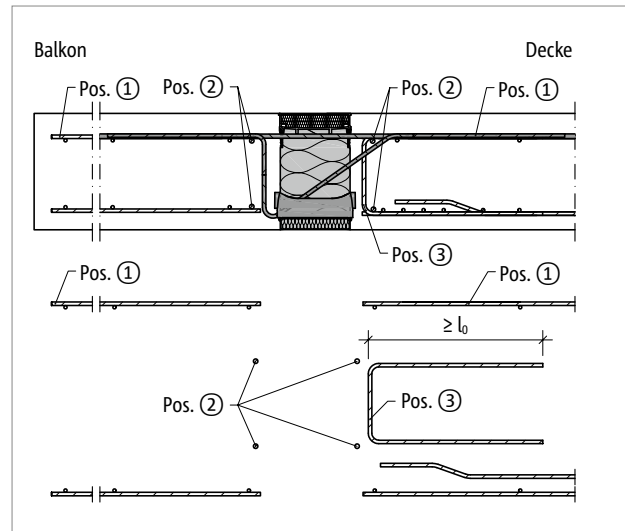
Schöck Isokorb® XT Typ K-M1 bis M10: Bauseitige Bewehrung bei indirekter Lagerung
